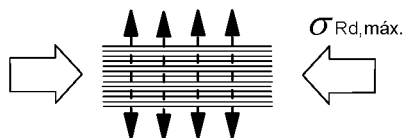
Resistencia de cálculo de las bielas de hormigón con tracción transversal
